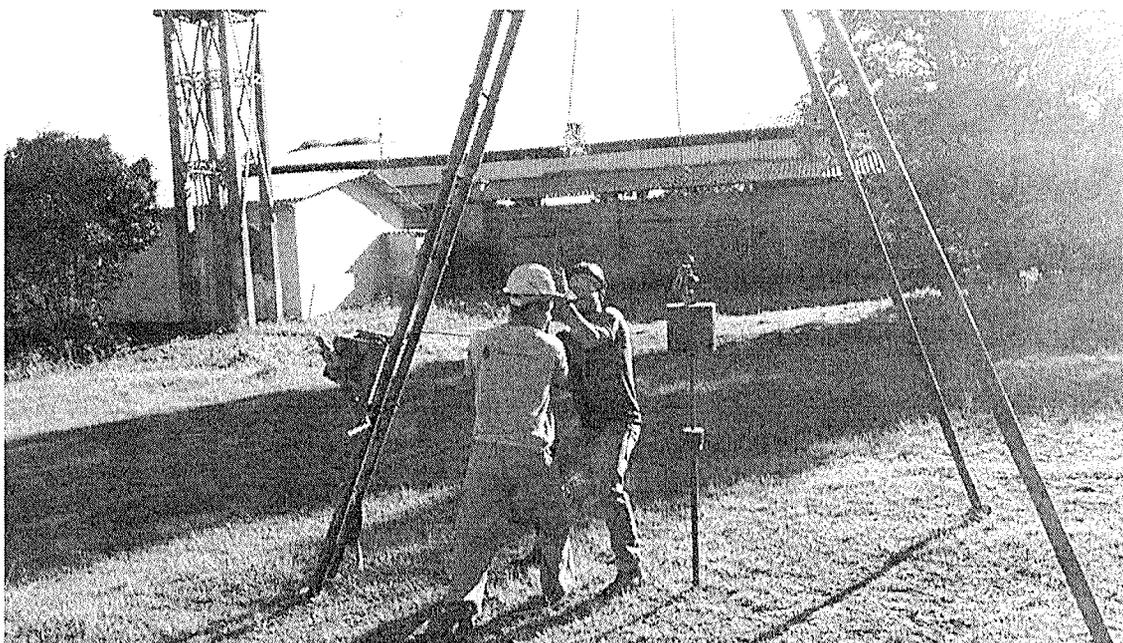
Perfuração do segundo furo. Foto Thiago Colaço.
